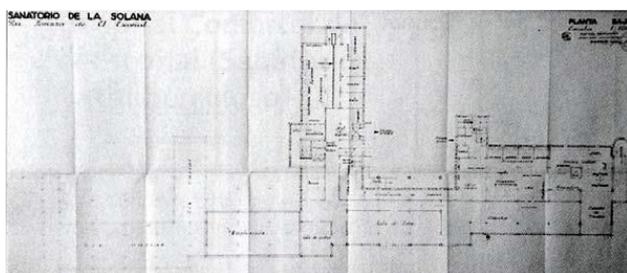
R. Bergamín. Proyecto Sanatorio La Solana, El Escorial, 1934-35. Planta tipo y baja (1935).
